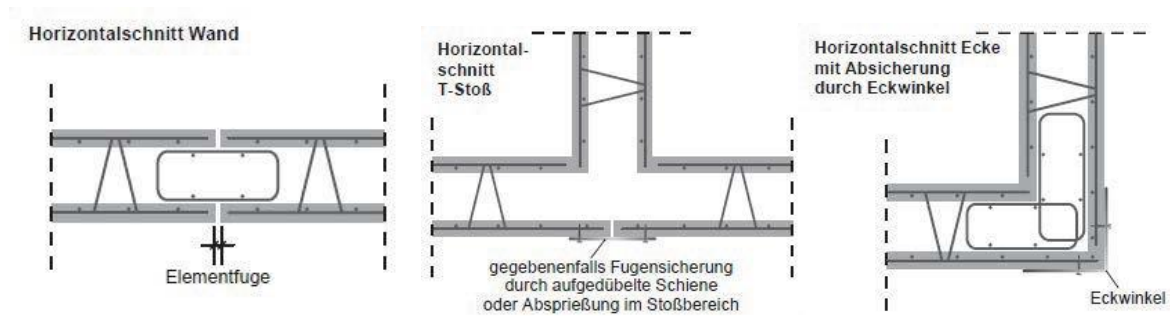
Elementstöße Doppelwand, [Fachvereinigung Betonbauteile, 2009], S.5
